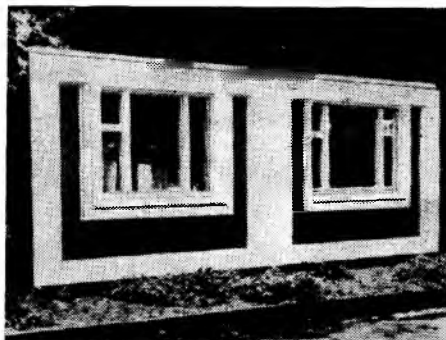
Трехслойная панель наружной стены жилого дома серии КОПЭ-80
